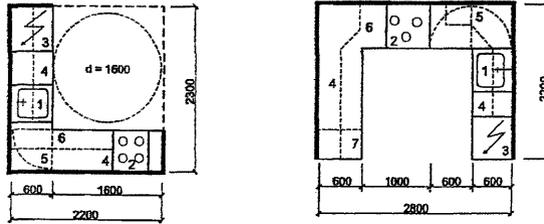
Кухонный фронт для семьи с инвалидом (с “Г” и “П”-образным размещением оборудования); 1 - мойка; 2 - электроплита; 3 - холодильник; 4 – полки навесные; 5 - полки поворотные; 6 - стол консольный; 7 - тумба
